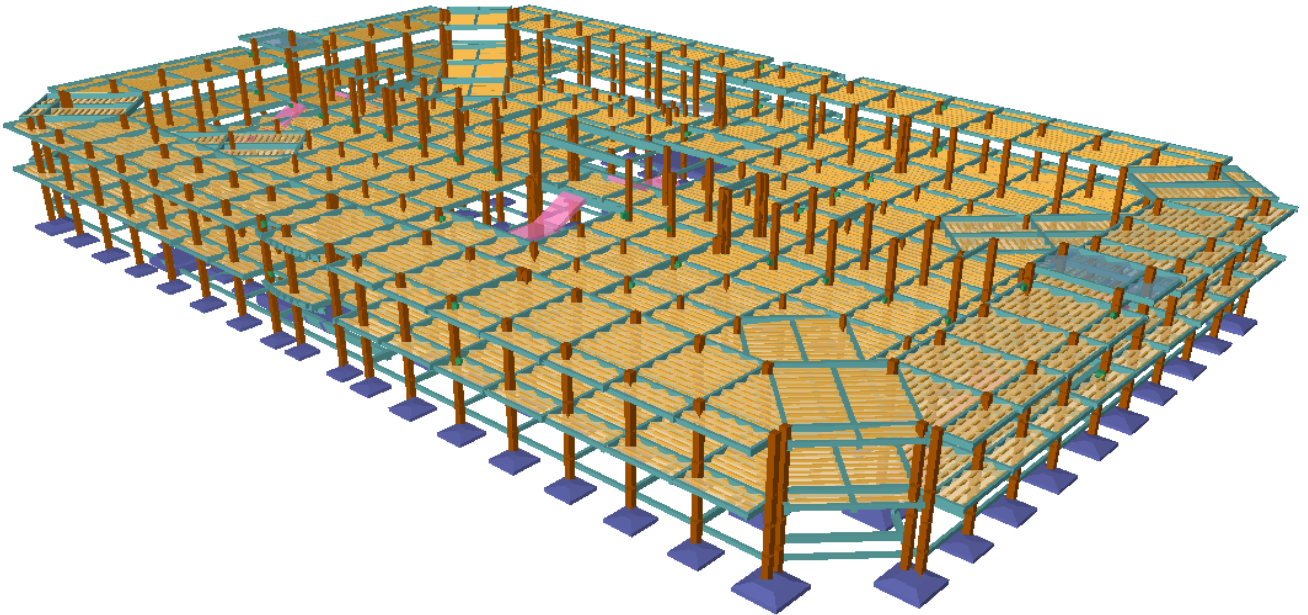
Modelo estructural del mercado. (elaboración propia)
